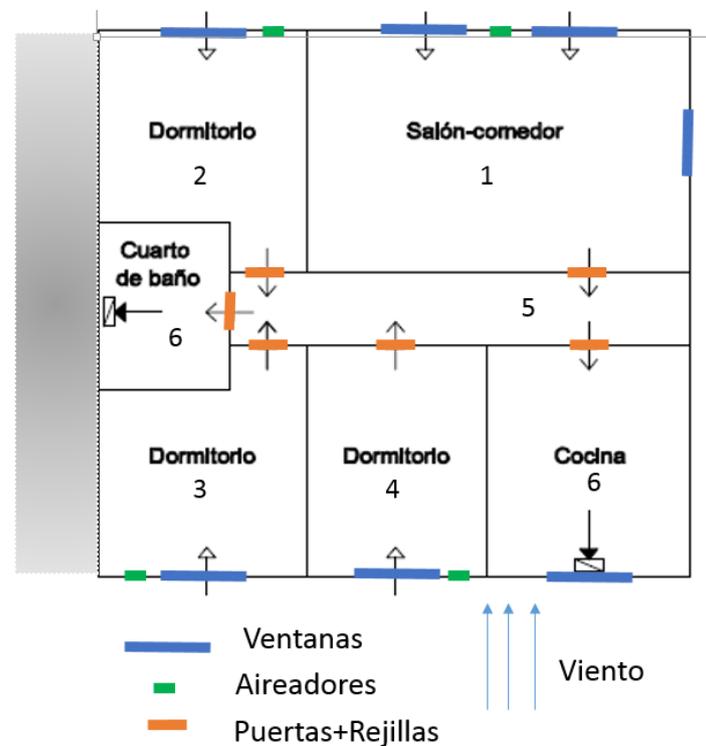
Elementos constructivos de la fachada y de conexión entre espacios
